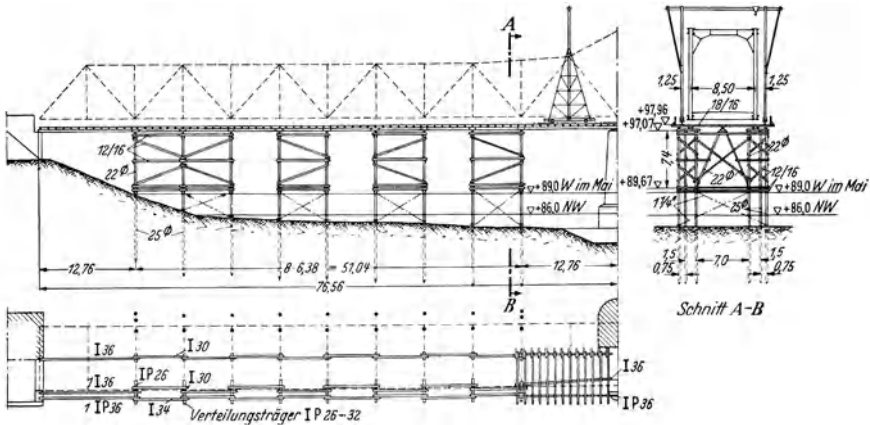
Aufstellgerüst der Straßenbrücke über die Düna.
